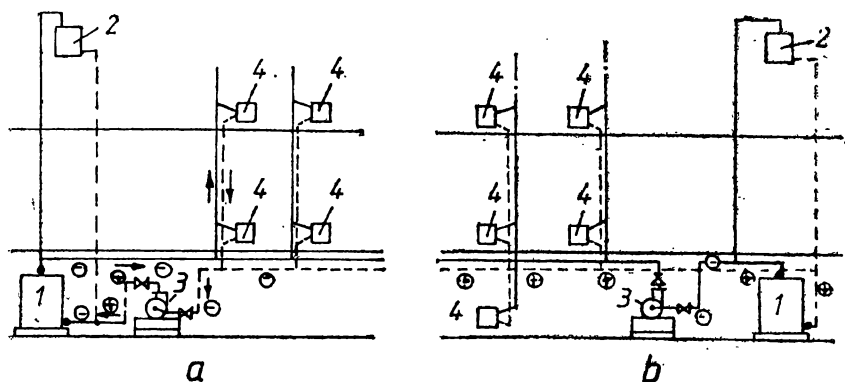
Instalații de încălzire cu apă și circulație forțată:
